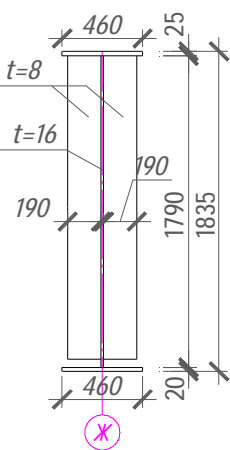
Поперечное сечение подкрановой балки по осям «Е» и «Ж» для кранов пролета «Е–Ж» на отметке 16 м.
